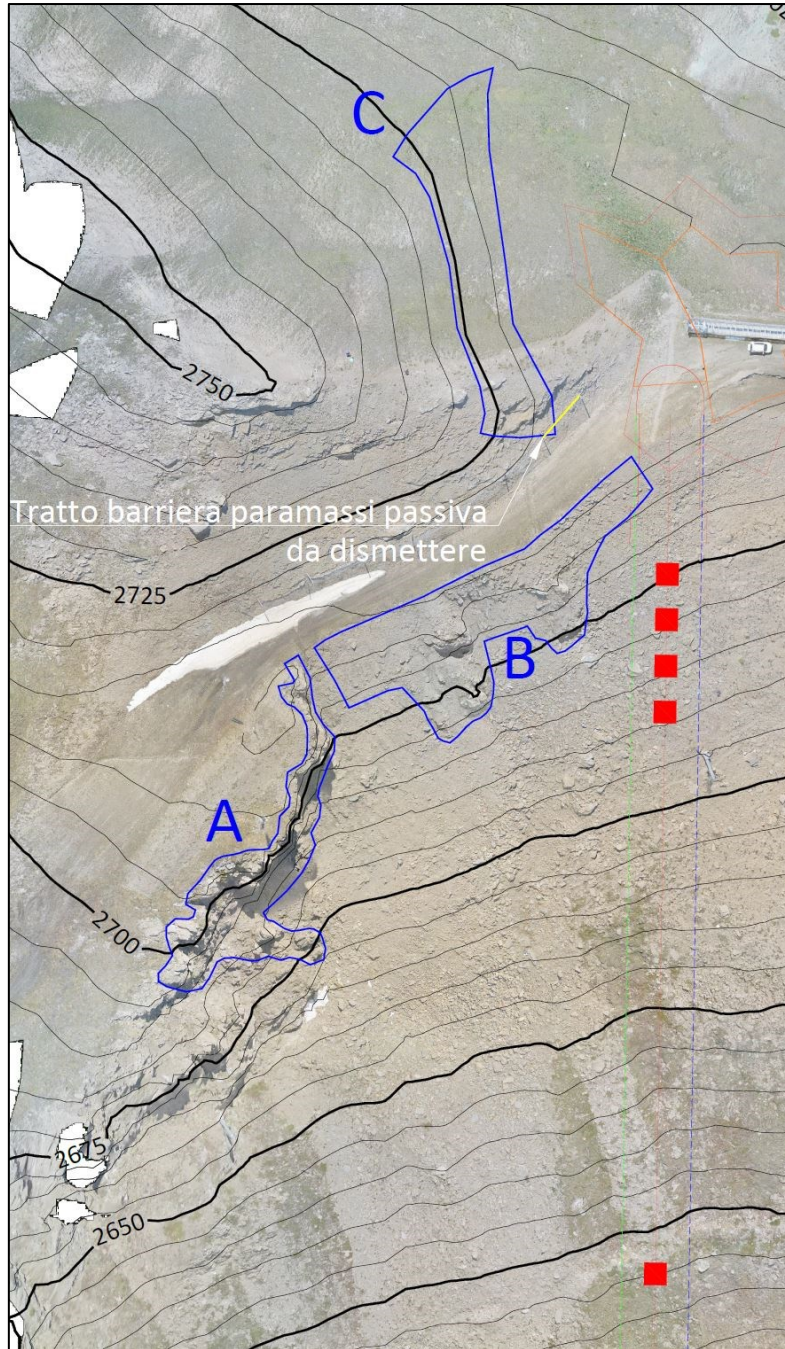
ESTRATTO PLANIMETRIA SUVISTA SETTORI A E B OGGETTO DI RIVESTIMENTO CORTICALE
